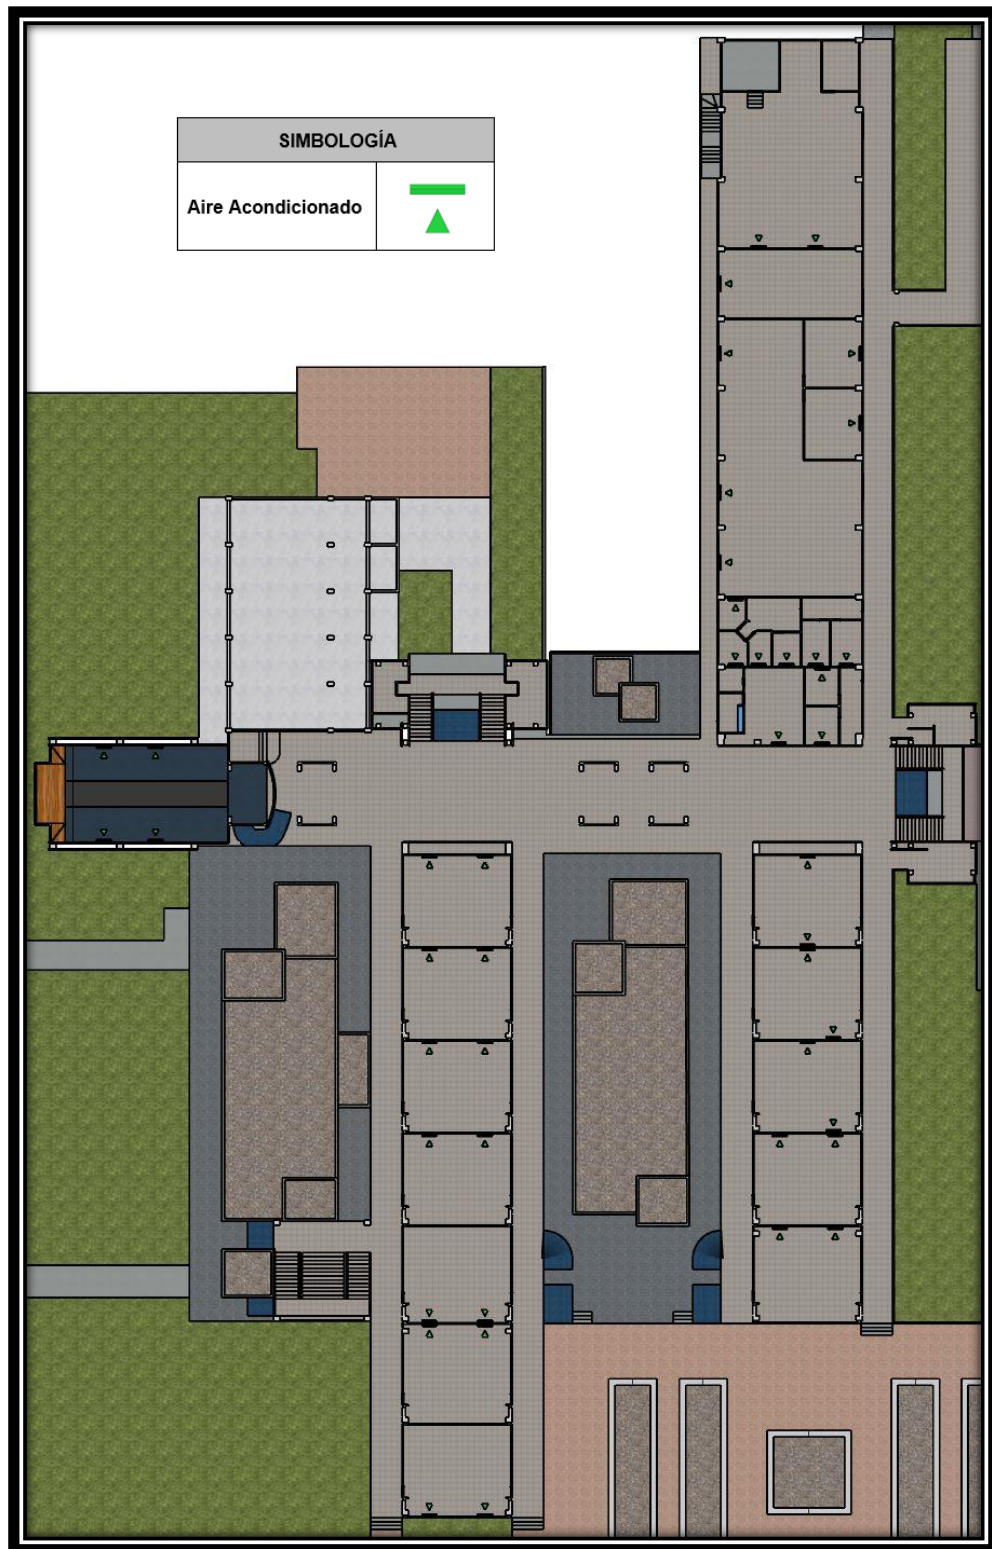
Aires Acondicionados - Planta Alta. Elaboración Propia
